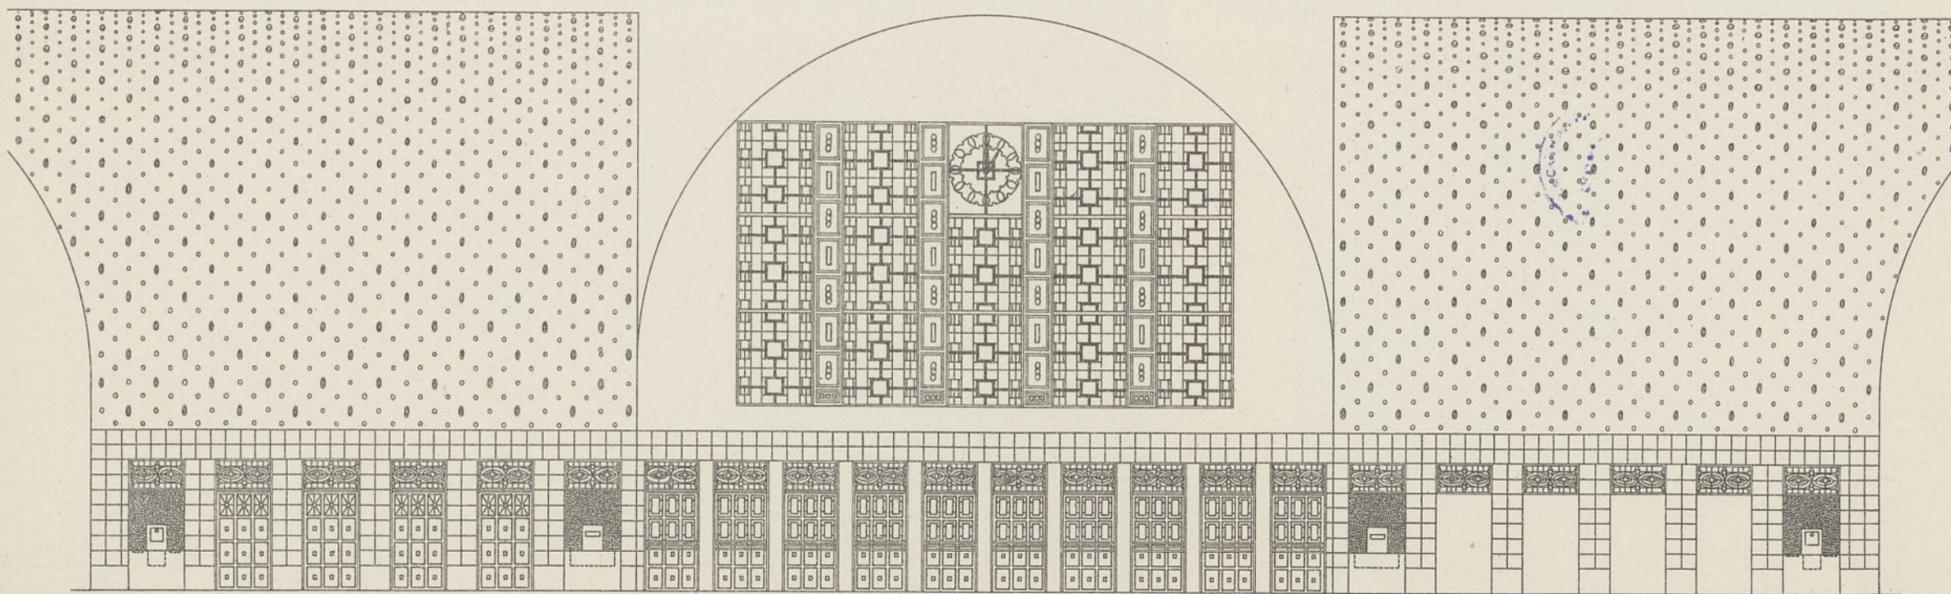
Stirnwand nach Norden mit anschließenden Seitenwänden.
